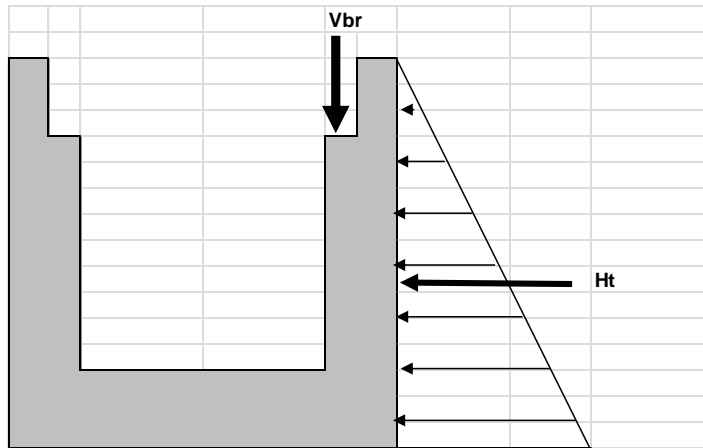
Schéma de l'effort transmis par la dalle et la poussée de terres sur le voile
